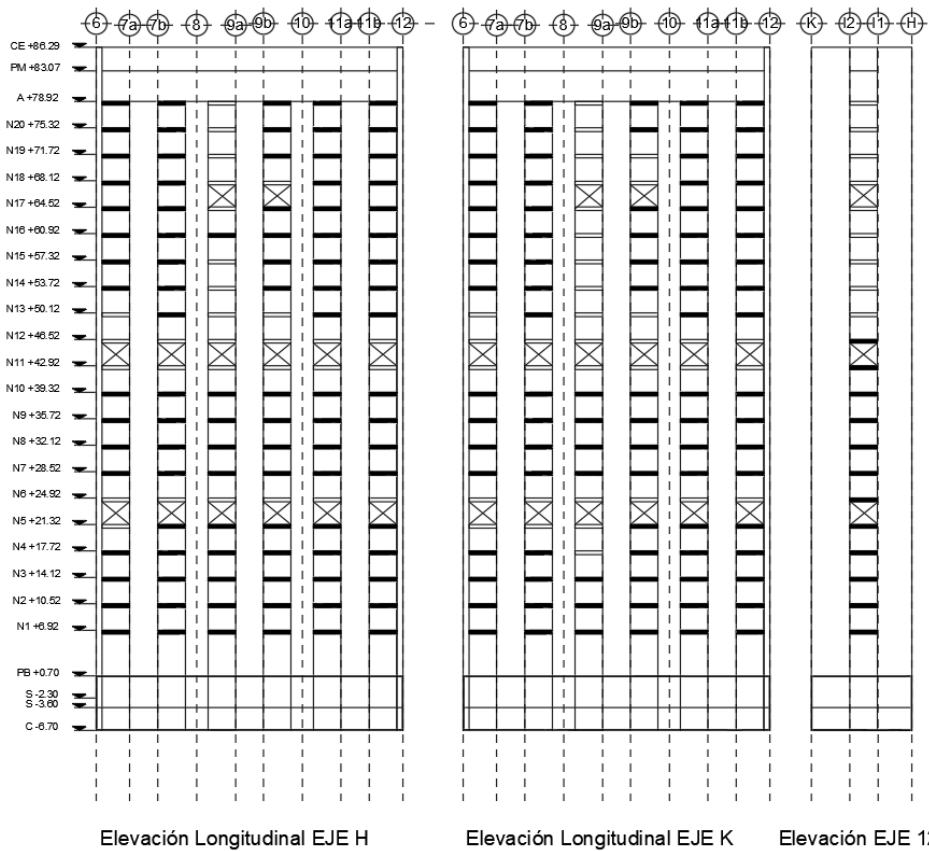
Distribución de cruces metálicas de contraviento en fachadas. Reforzamiento de vigas de acoplamiento (vigas sombreadas) (Aguilar, 2016).
